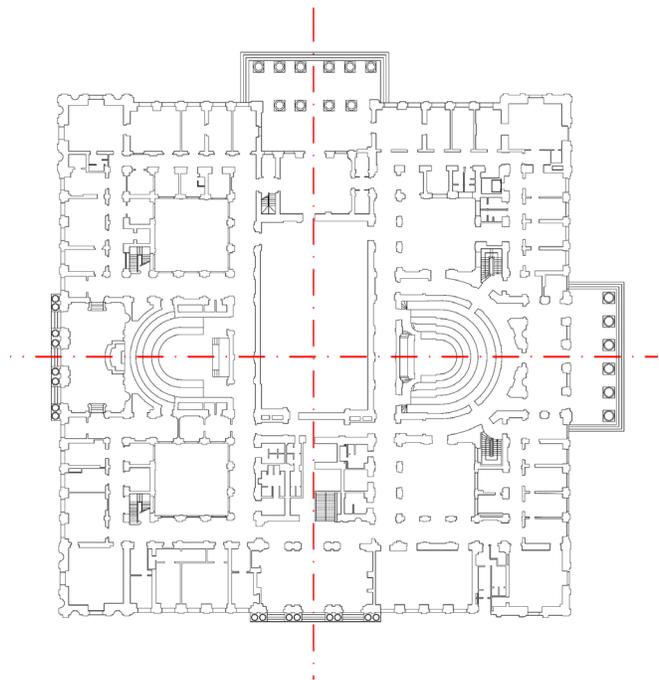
Simetría en planta Edificio ex Congreso Nacional. Elaboración propia
